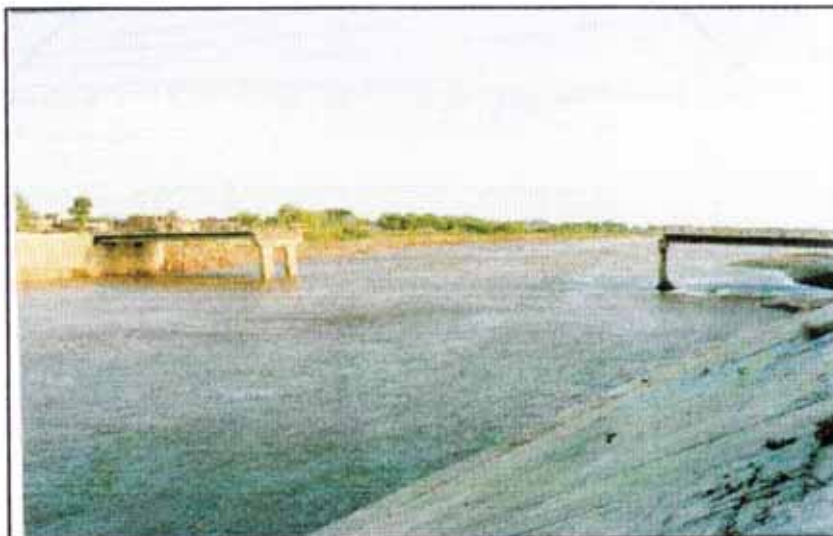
Erosión general del terraplén y colapso de la estructura de drenaje, asimismo erosión transversal del terreno de fundación.
